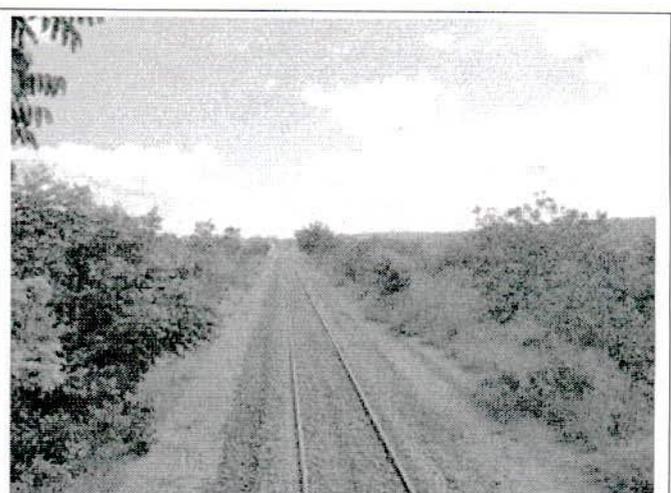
Segmento I: canaletas de drenagem de concreto implantadas nas saídas de cortes – estaca 410.
